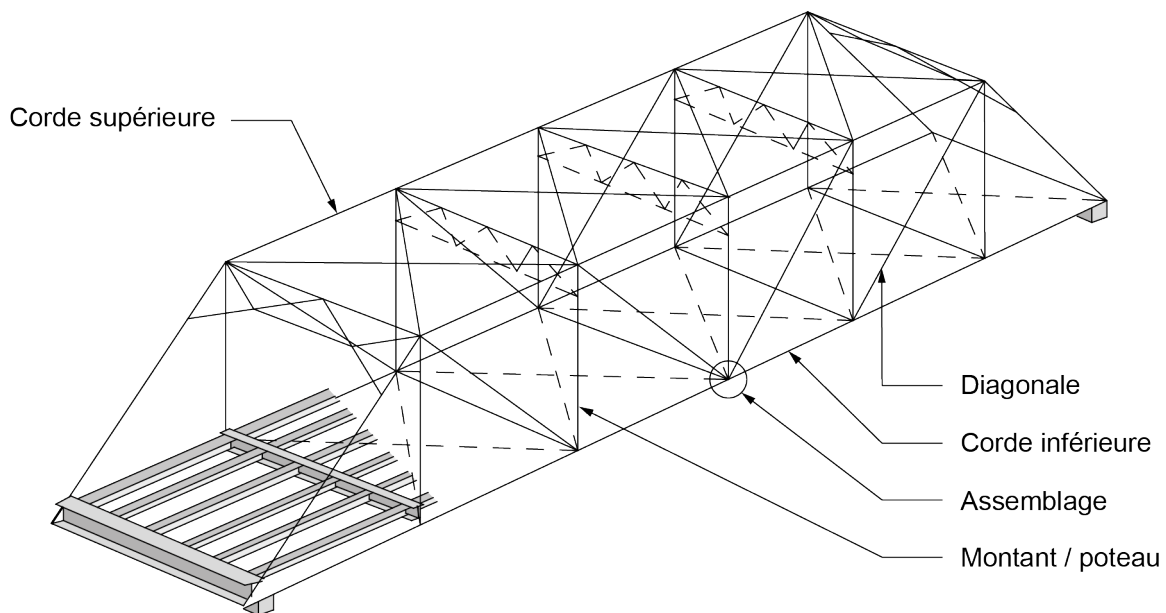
Pont à poutres triangulées à tablier inférieur en acier
